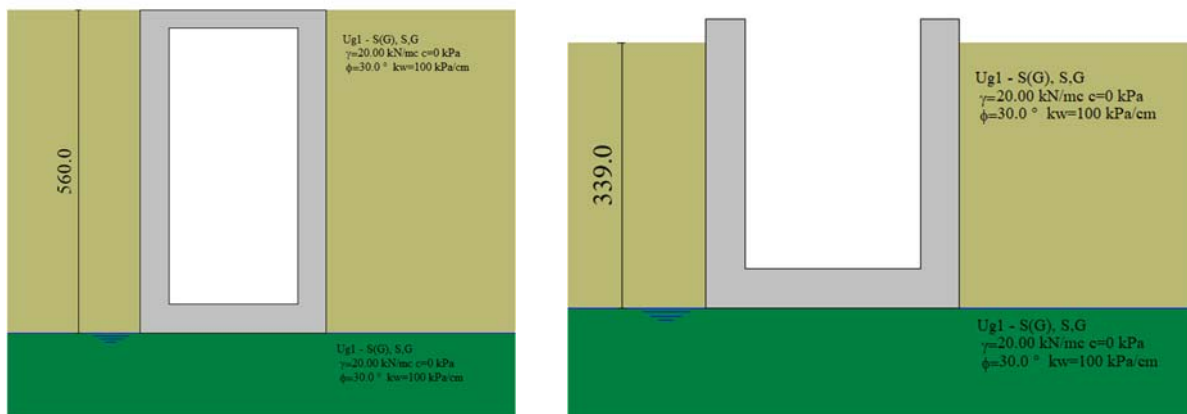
Modelli di calcolo struttura rampa scale: Sezione di calcolo A (sx) e Sezione di calcolo B (dx)
